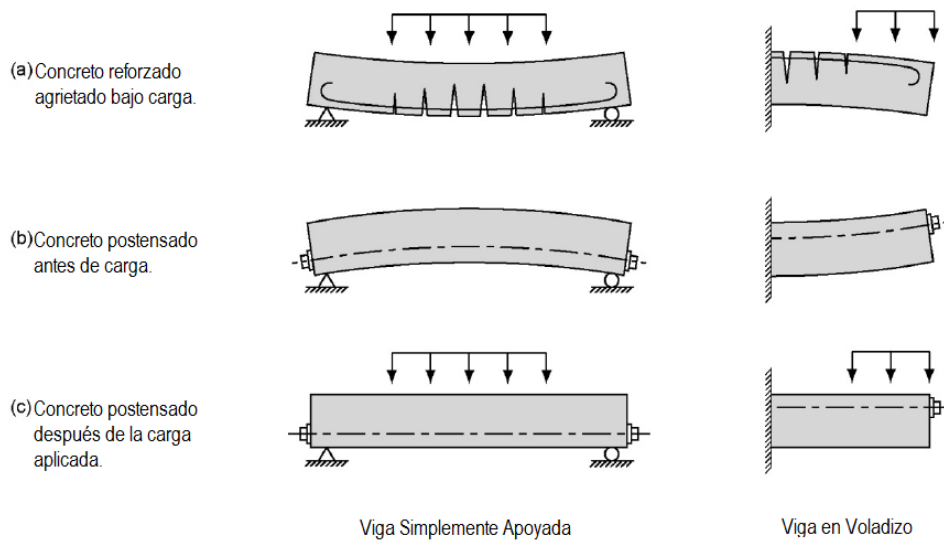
Comparación de vigas de concreto reforzadas y presforzadas *Fuente:* [3].
